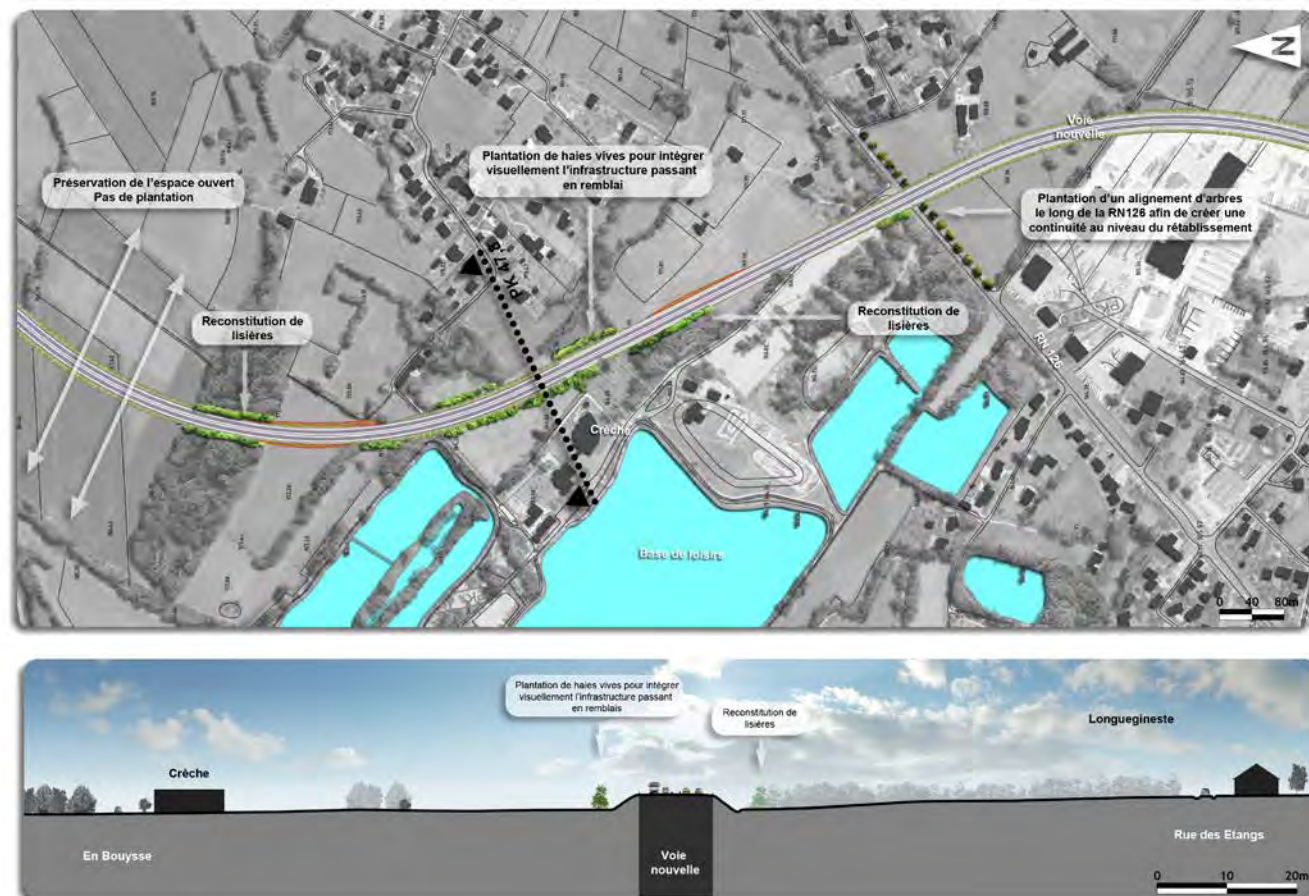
Exemples d'aménagements paysagers proposés au droit du Dicos (Saïx) : plan de masse et vue en coupe
